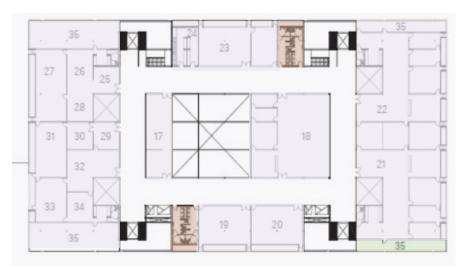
Planta segundo nivel del centro cívico Rafaela Fuente: archdaily
